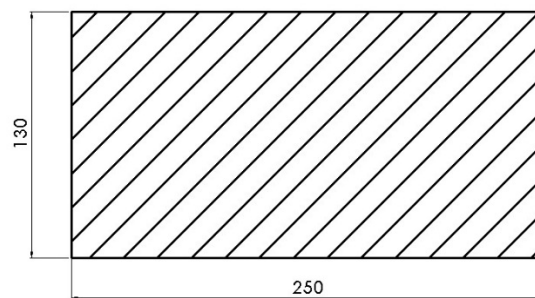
Dimensiones de la sección rectangular maciza en mm (Fuente: propia)
